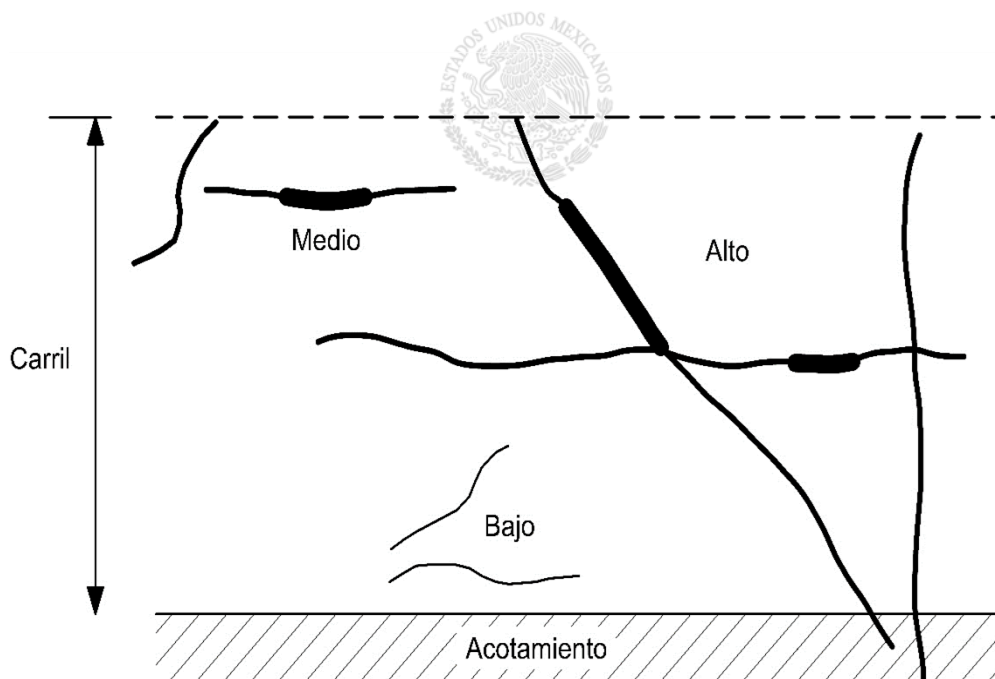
Esquema del nivel de severidad del deterioro “grietas aisladas” (vista en planta)
